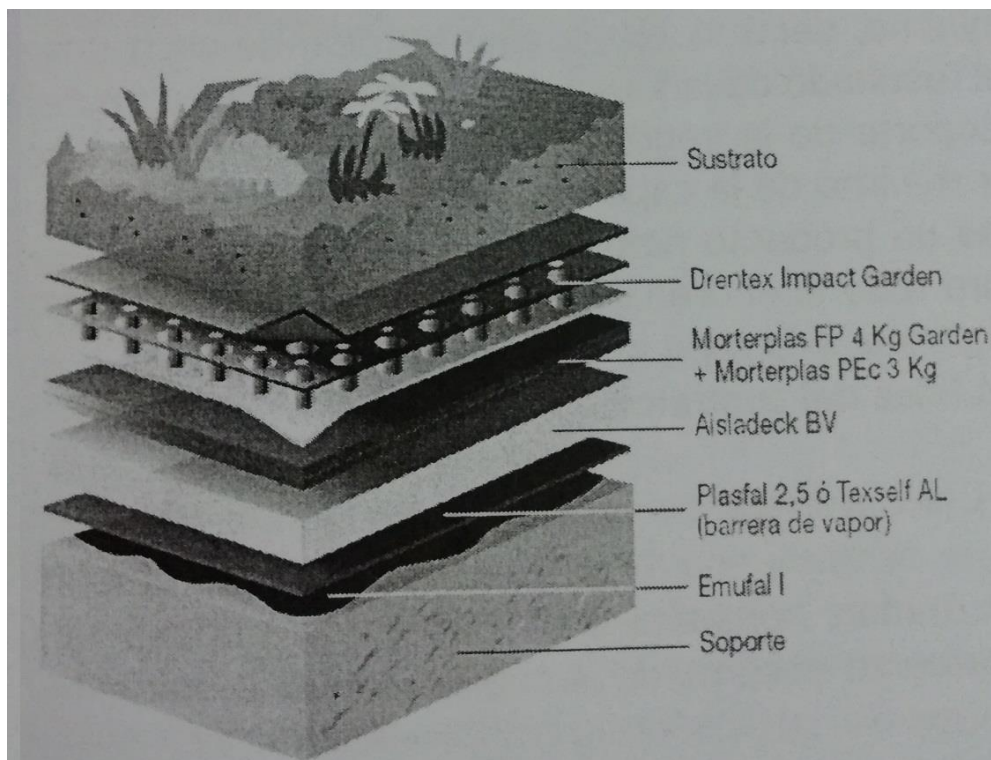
Detalle constructivo de las cubiertas ajardinadas extensivas.
